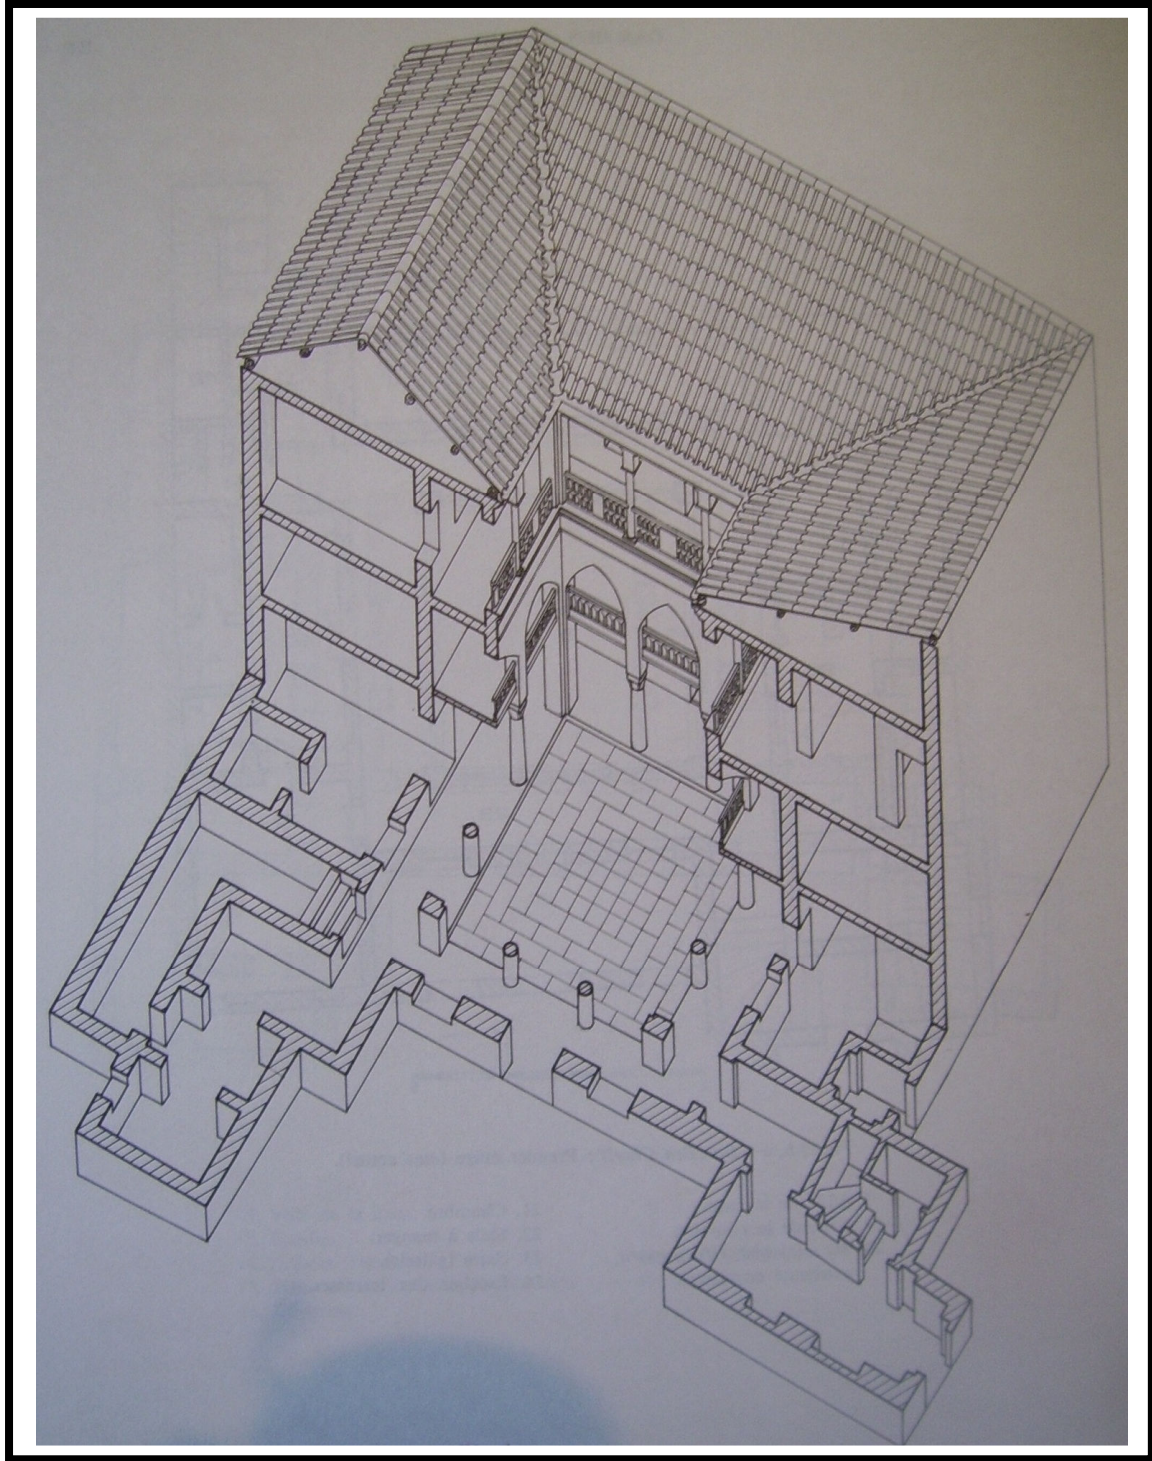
مخطط الطابق الأول لدار بن شريف (عن سوسن)
